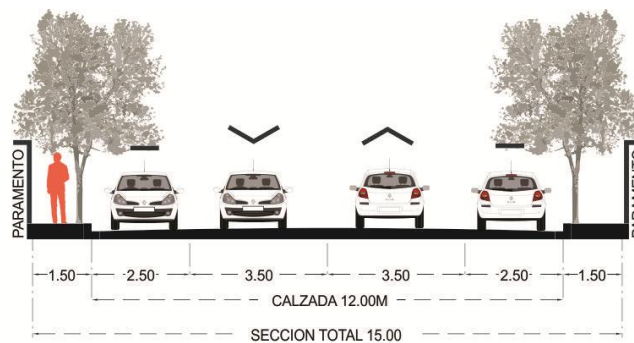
Sección Vialidad Acceso a Colonia, mínimo de banqueta.
